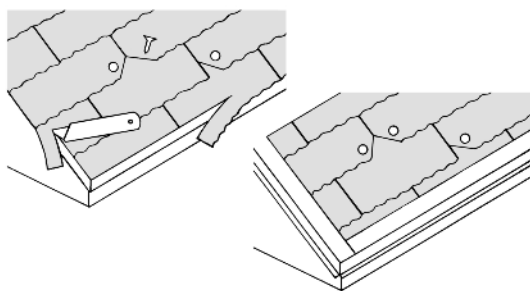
Préparation d'un vieux toit pour sa réfection.
